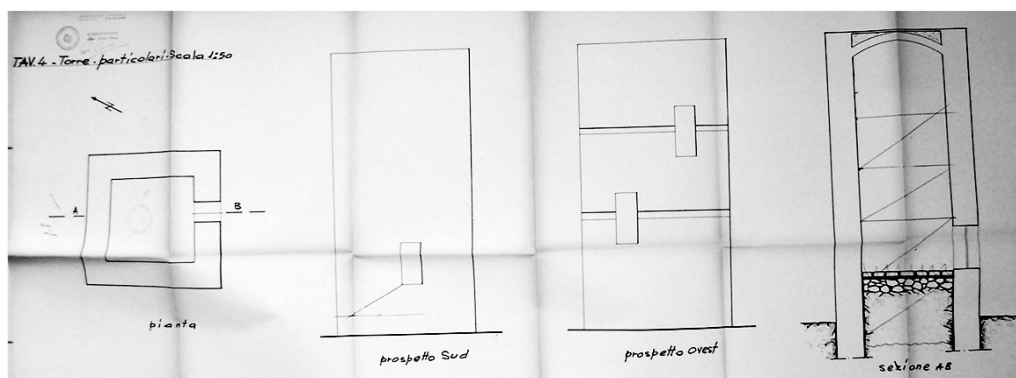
Castello di Burgos, pianta prospetto e sezione per i lavori di consolidamento e restauro del 1962 (ASBAPSS)
